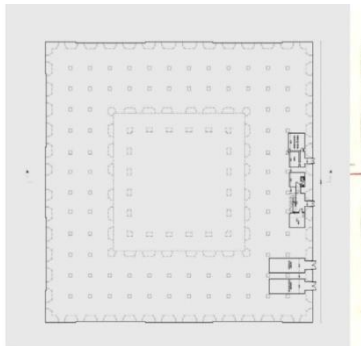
Planta semisótano. Levantamiento del estado actual. Anterior al proyecto de rehabilitación. Año 2005
